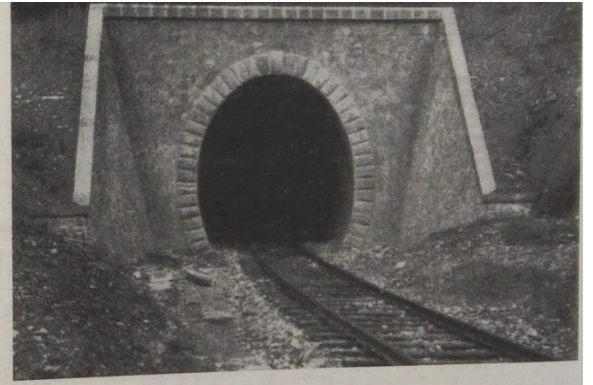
Galleria di Ponzano : imbocco sud : ricostruito.
